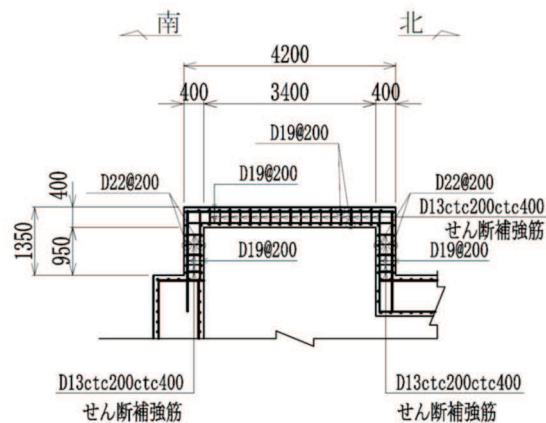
復水貯蔵タンク基礎 概略配筋図 (6-6 断面)
